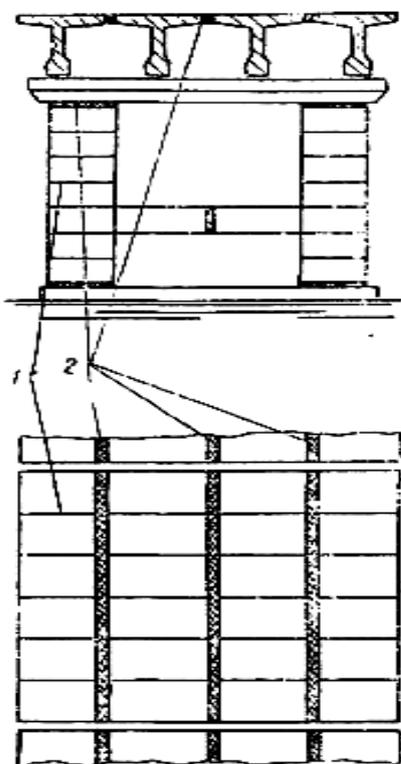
Схема расположения стыков в составных конструкциях: 1-сухие или клееные стыки; 2-бетонизируемые стыки
